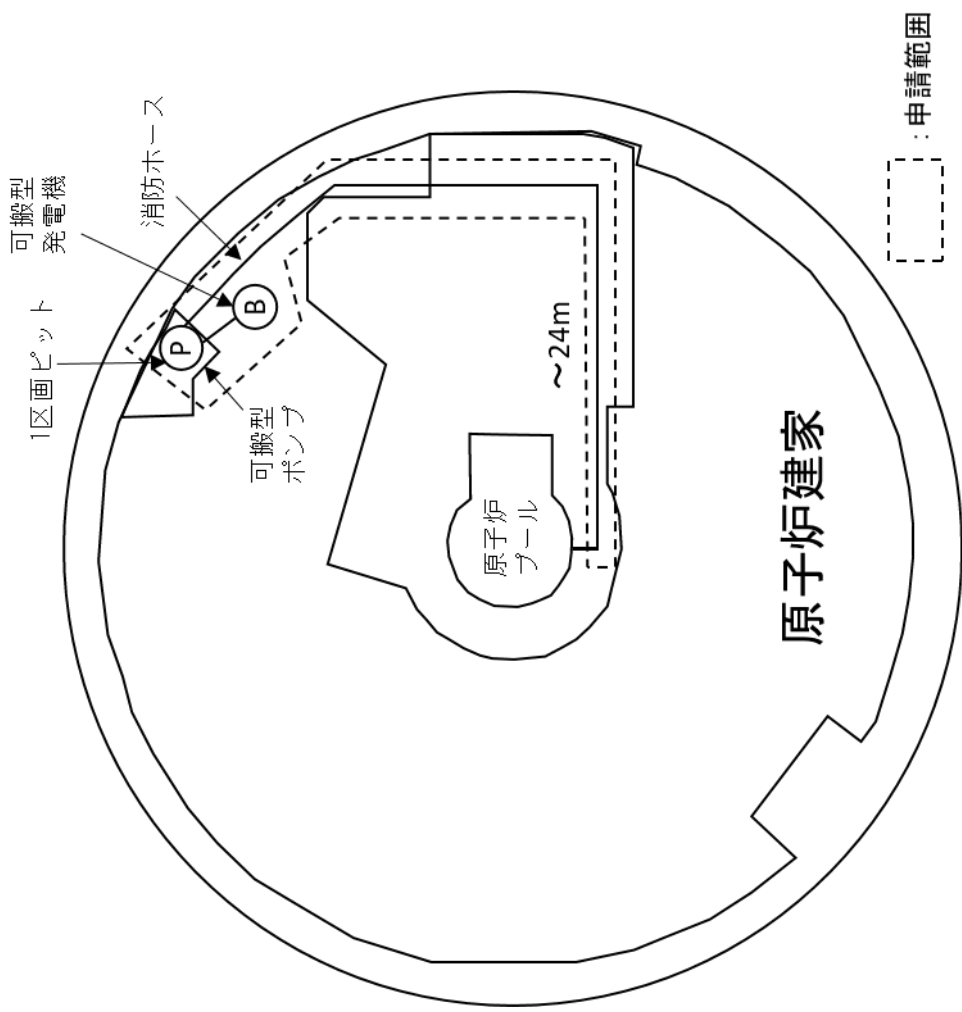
原子炉建家内の冠水維持機能喪失時用水設備配置イメージ図（平面図）
